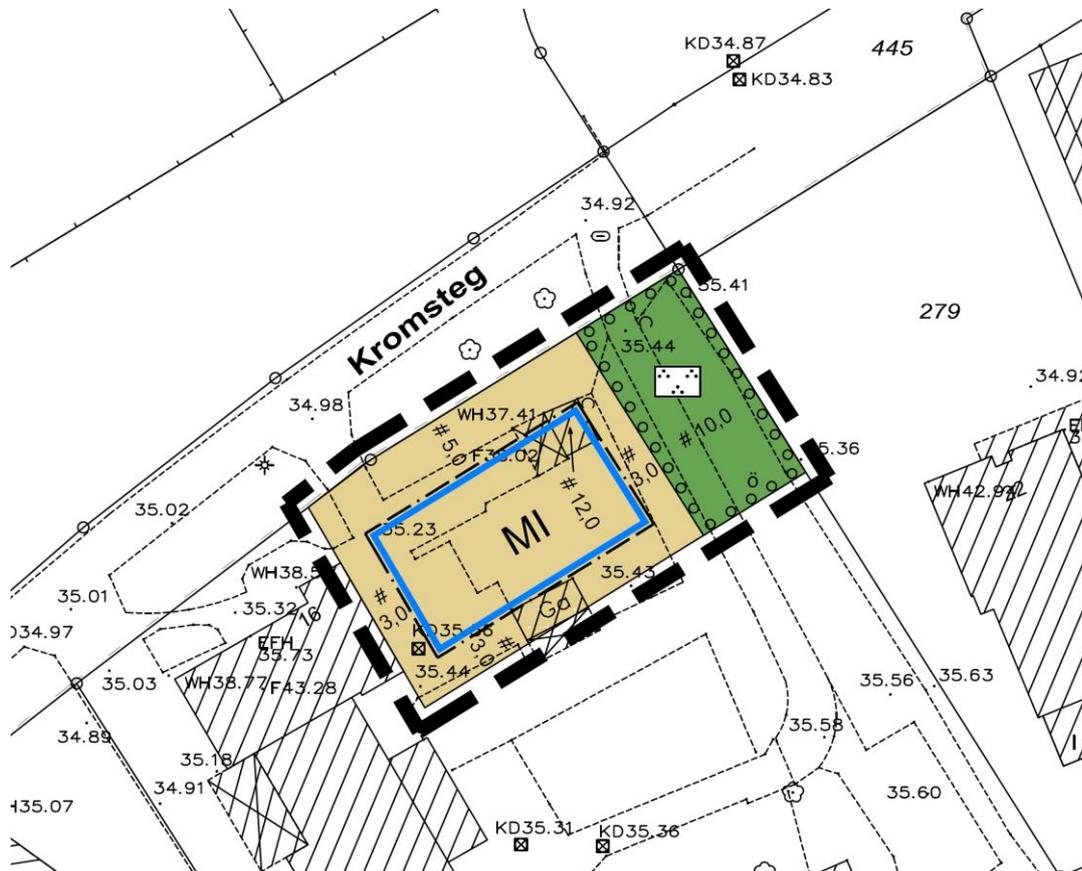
Ausschnitt Entwurf Bebauungsplan Nr. 33 - 4. Änderung (Büro STADTUMBAU, Kevelaer)
